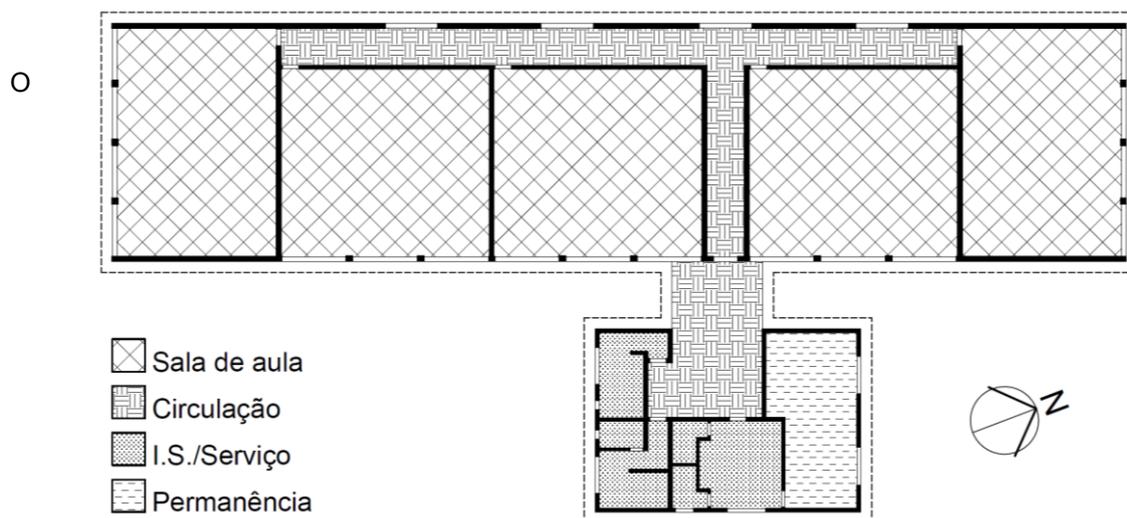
Planta baixa esquemática do pavilhão de desenho.
